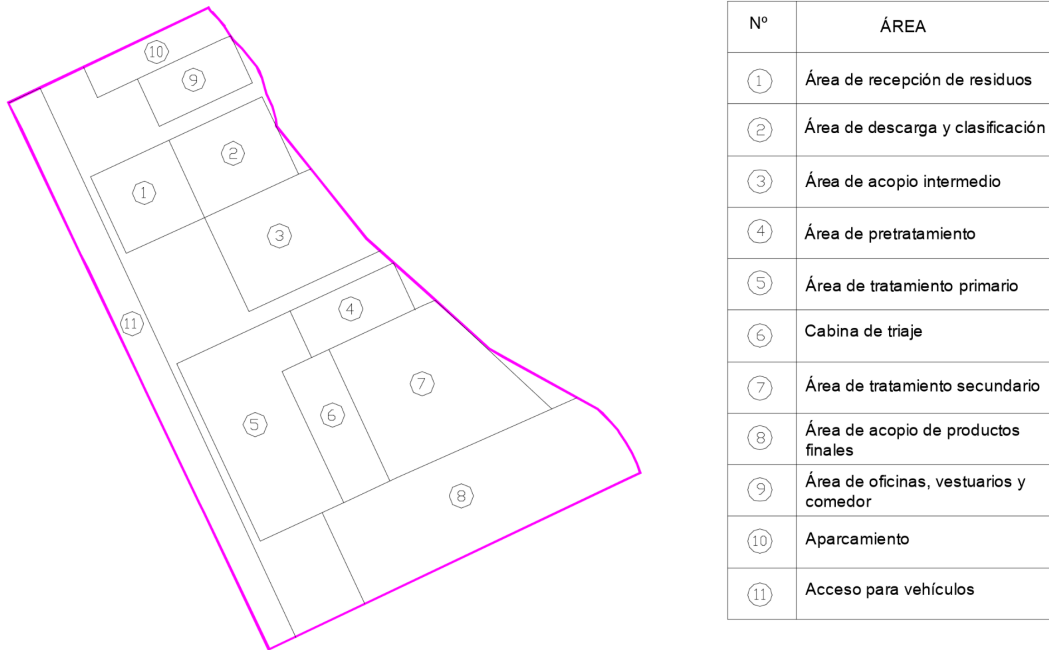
Plano de la planta de tratamiento de RCD separada por áreas
